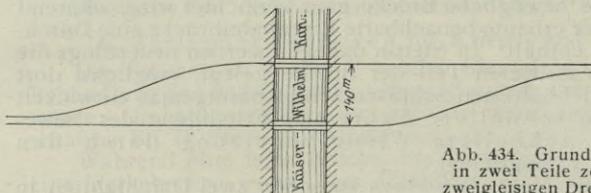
Grundriß einer in zwei Teile zerlegten zweigleisigen Drehbrücke.
